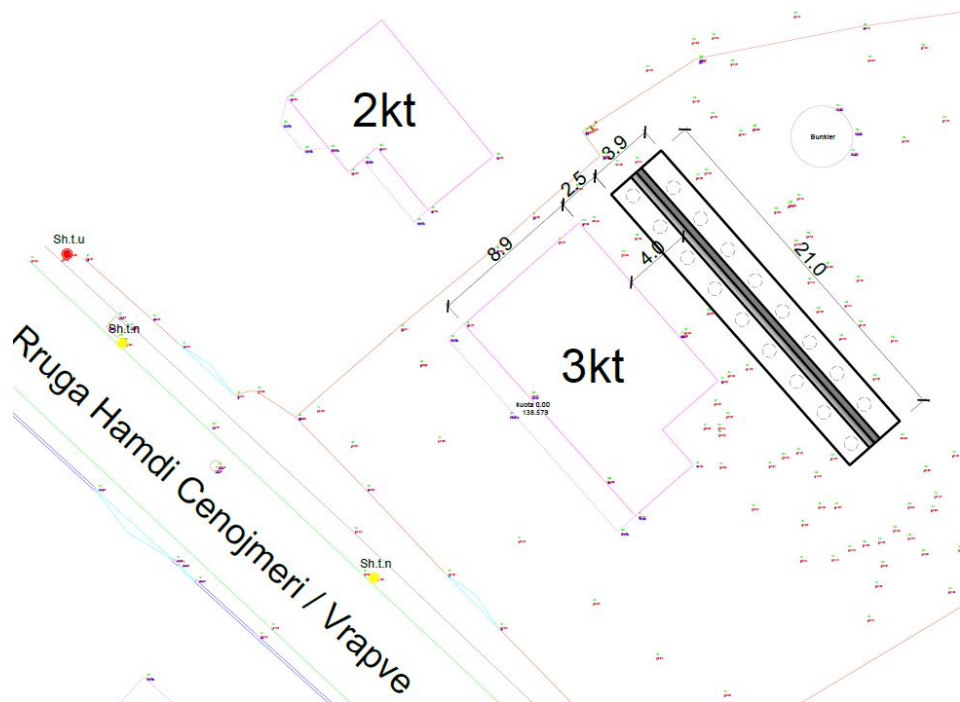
Planvendasje së murit mbajtës me pilota
